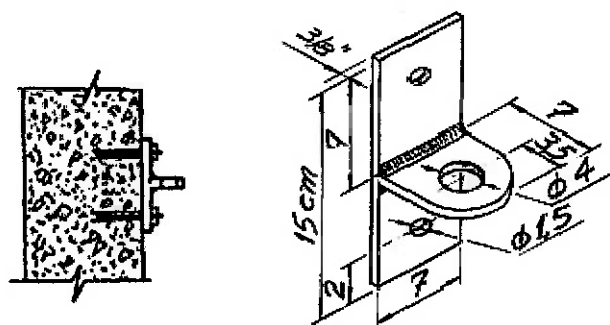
Placa de fixação (fonte: o TST Brinks)
